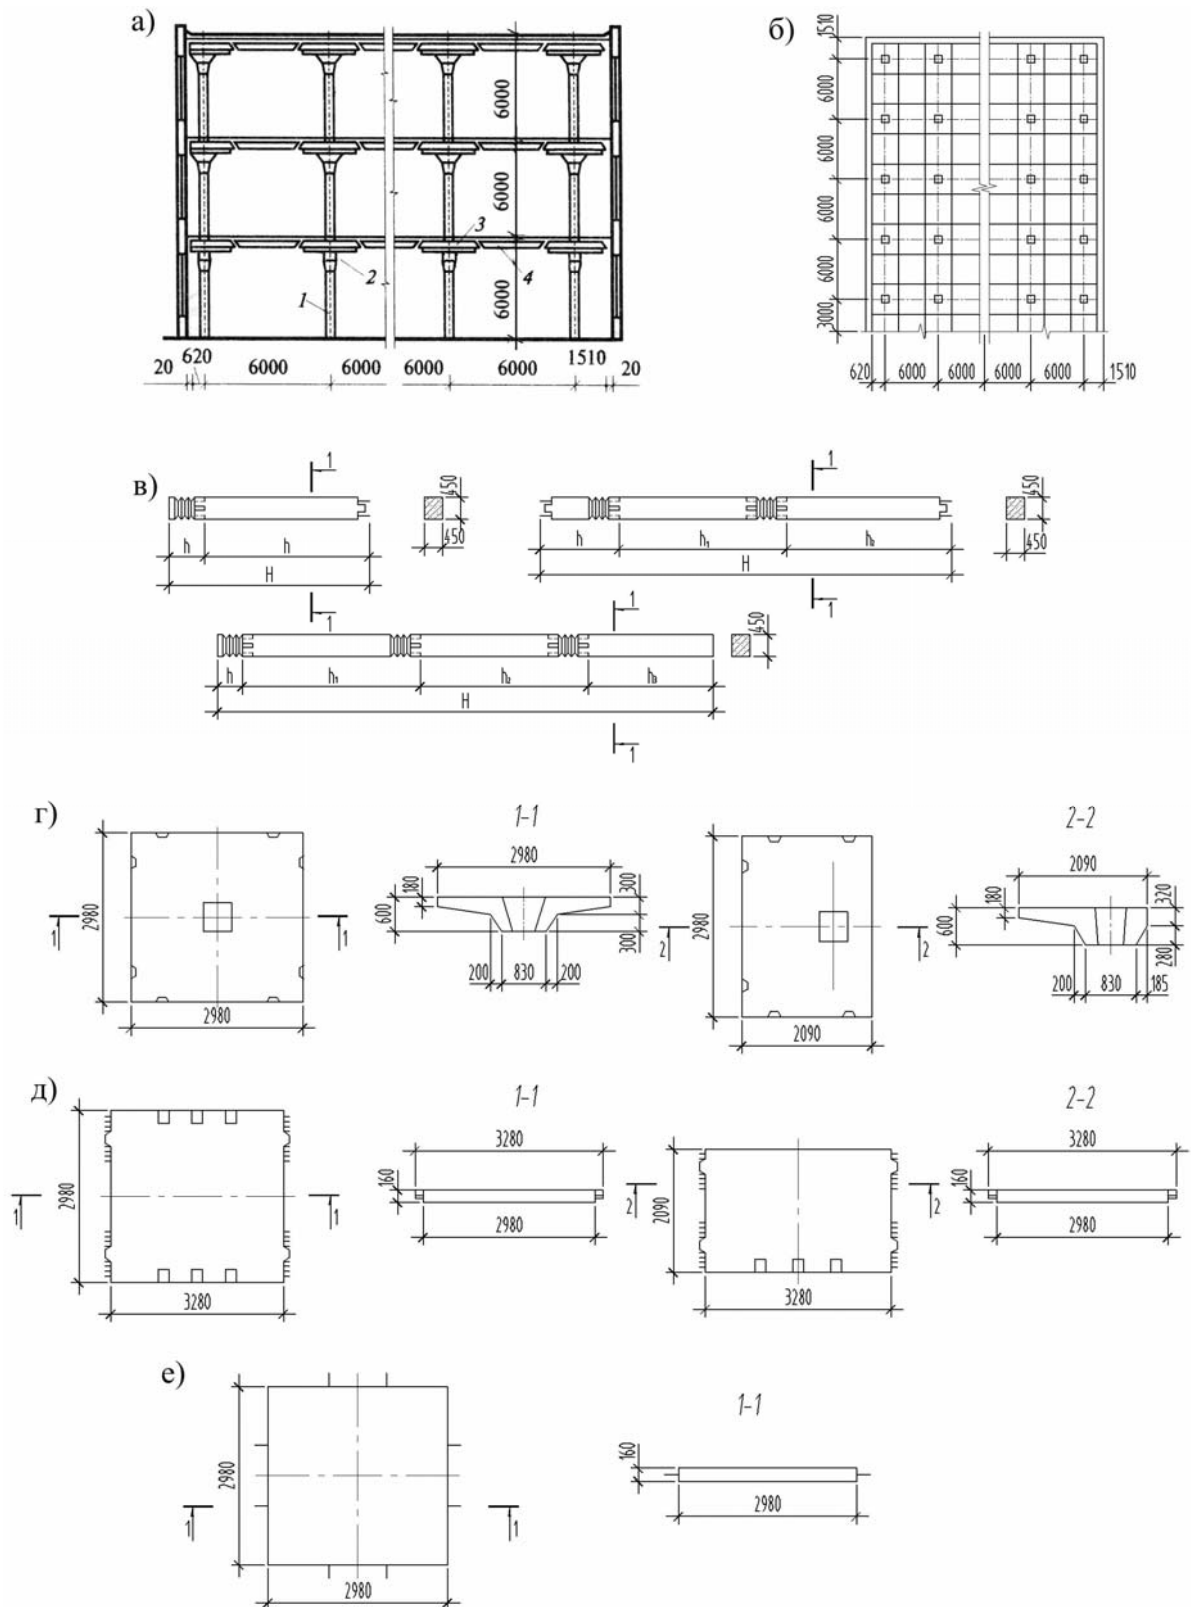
Многоэтажные здания с безбалочными перекрытиями:
